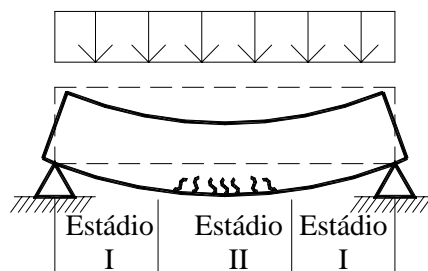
Comportamento estrutural típico de uma viga de concreto armado biapoiada
